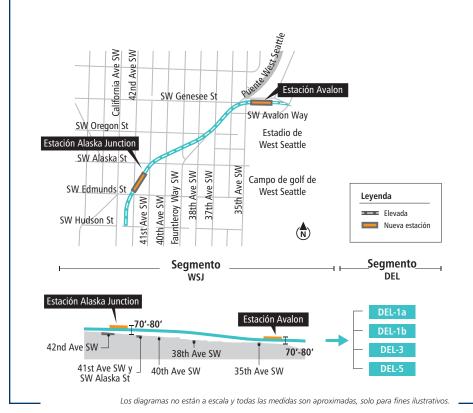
Segmento West Seattle Junction: alternativa elevada de la estación en 41st/42nd Avenue (WSJ-1)
